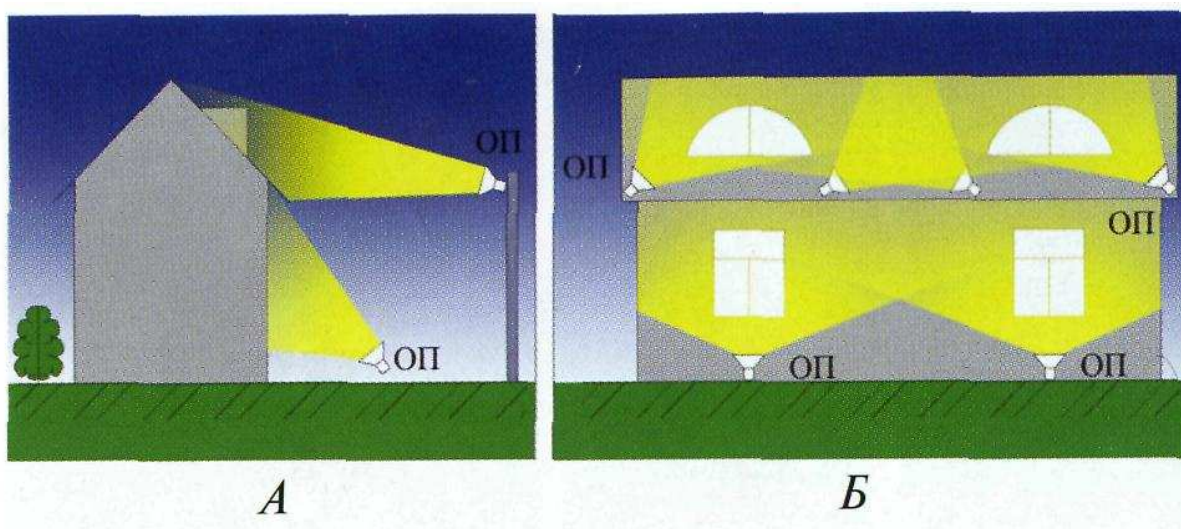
Возможное размещение прожекторов для освещения фасадов здания и кровли
